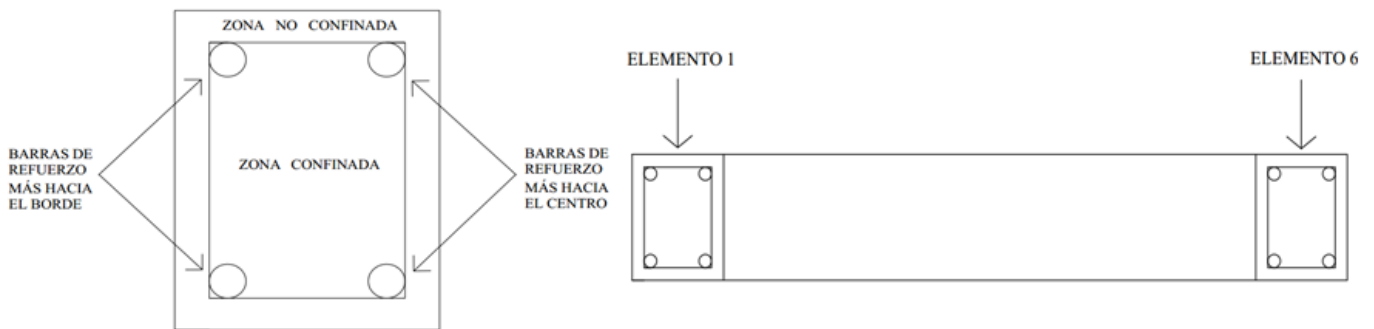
Esquema del elemento 1 con zonas del hormigón y descripción de la ubicación de los elementos 1 y 6 en la planta del muro base.
